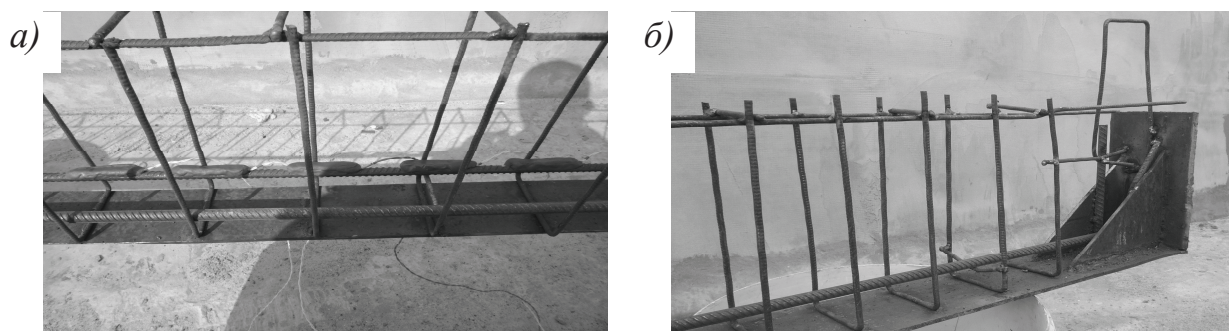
Каркаси сталобетонних дослідних балок із зчепленням стрічкової арматури з бетоном: а) вигляд в зоні чистого згину; б) вигляд опорної ділянки
